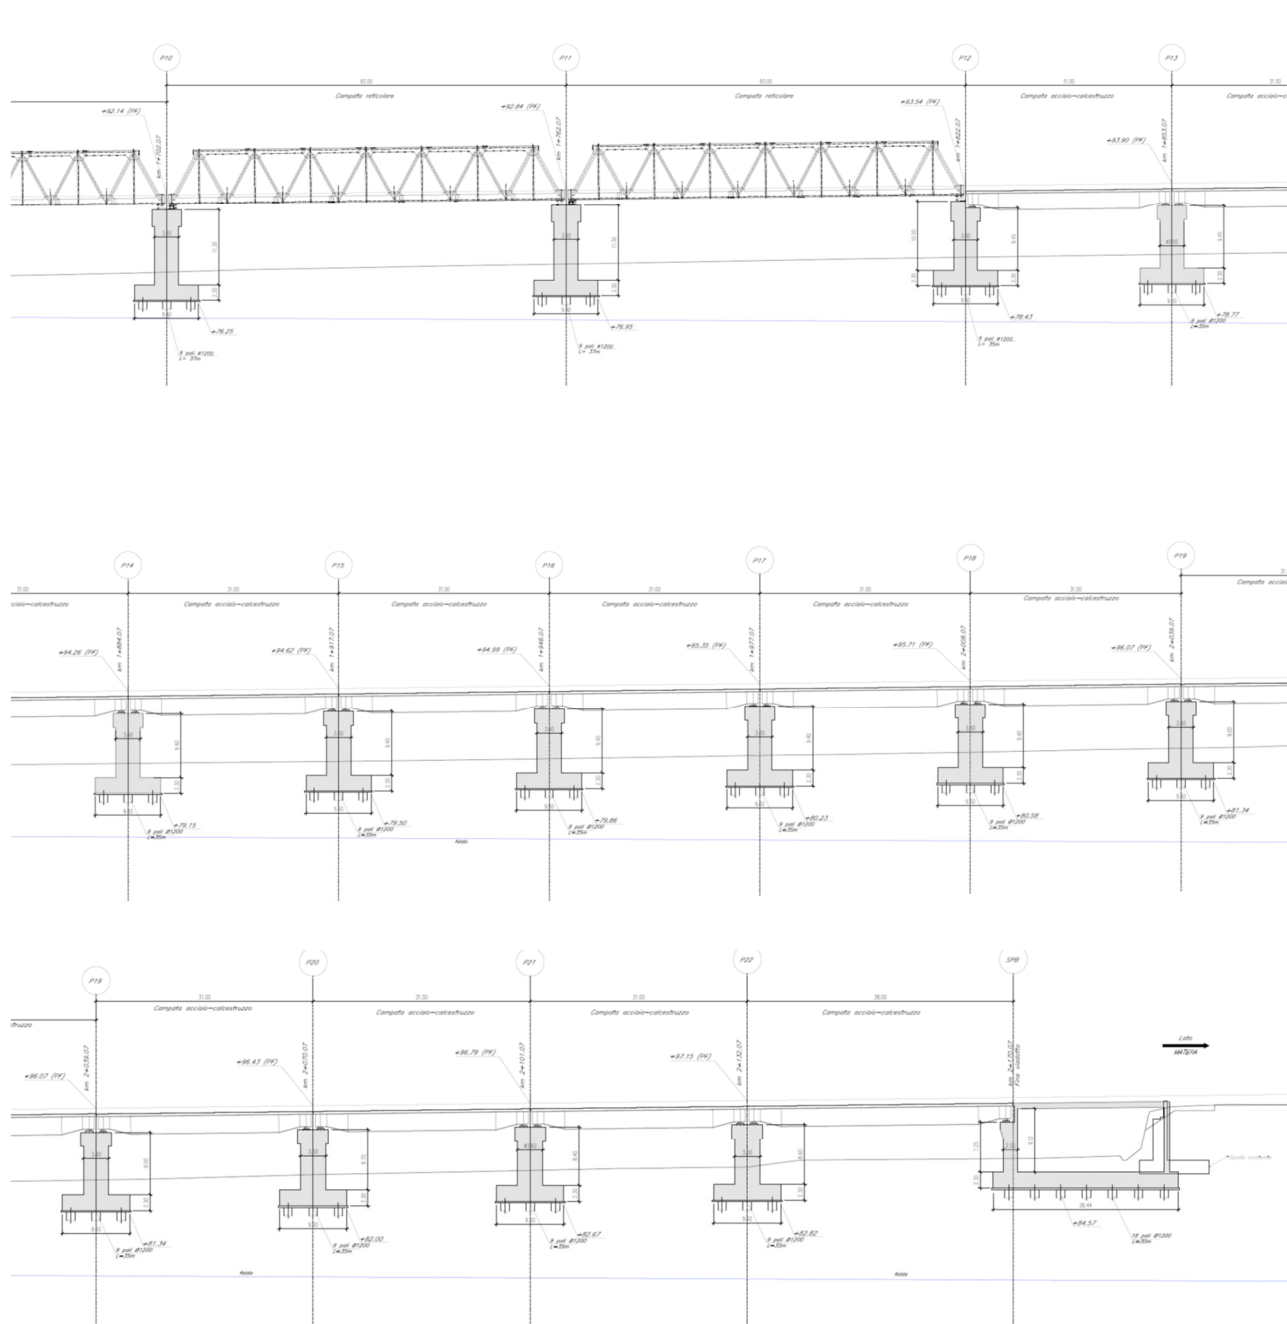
Sezione longitudinale viadotto VI13 Nuovo Basento
